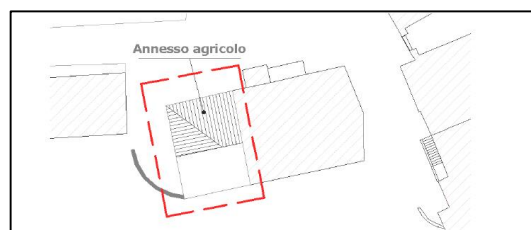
Stralcio planimetrico relativo all'annesso rurale
